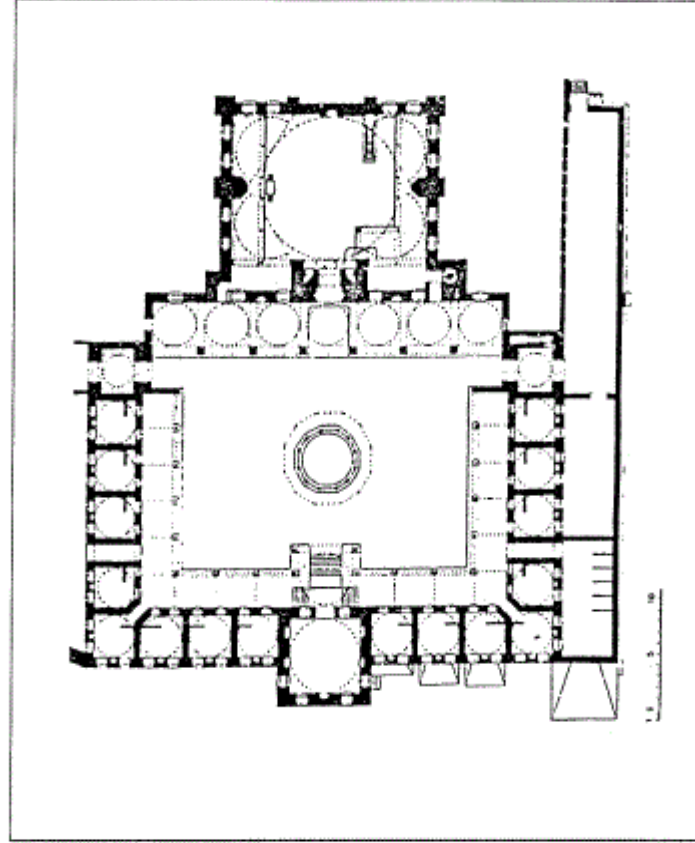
مسقط أفقي لمدرسة رستم باشا في استانبول (عن : كوران) .
